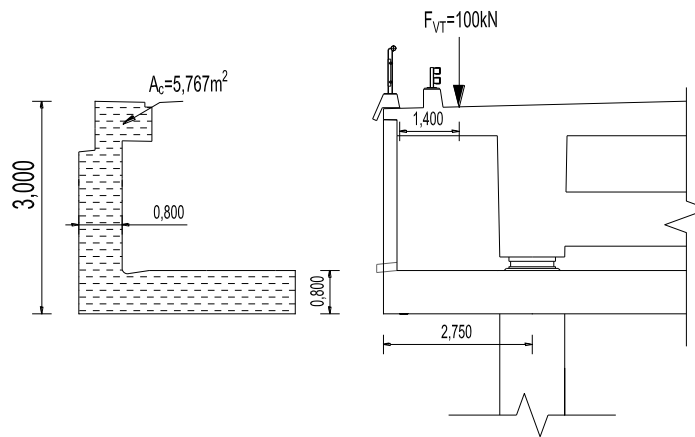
Modelo de cálculo da viga de estribo do encontro E1 devido às ações do PP e do VT
